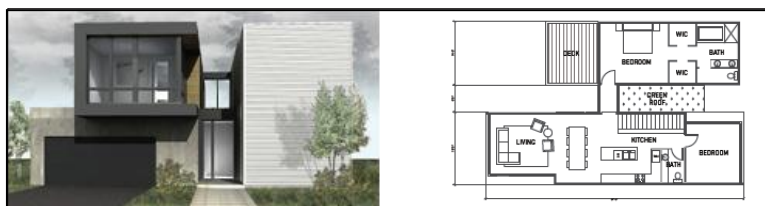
Elemental 4 – volume e planta baixa (www.methodhomes.net)
